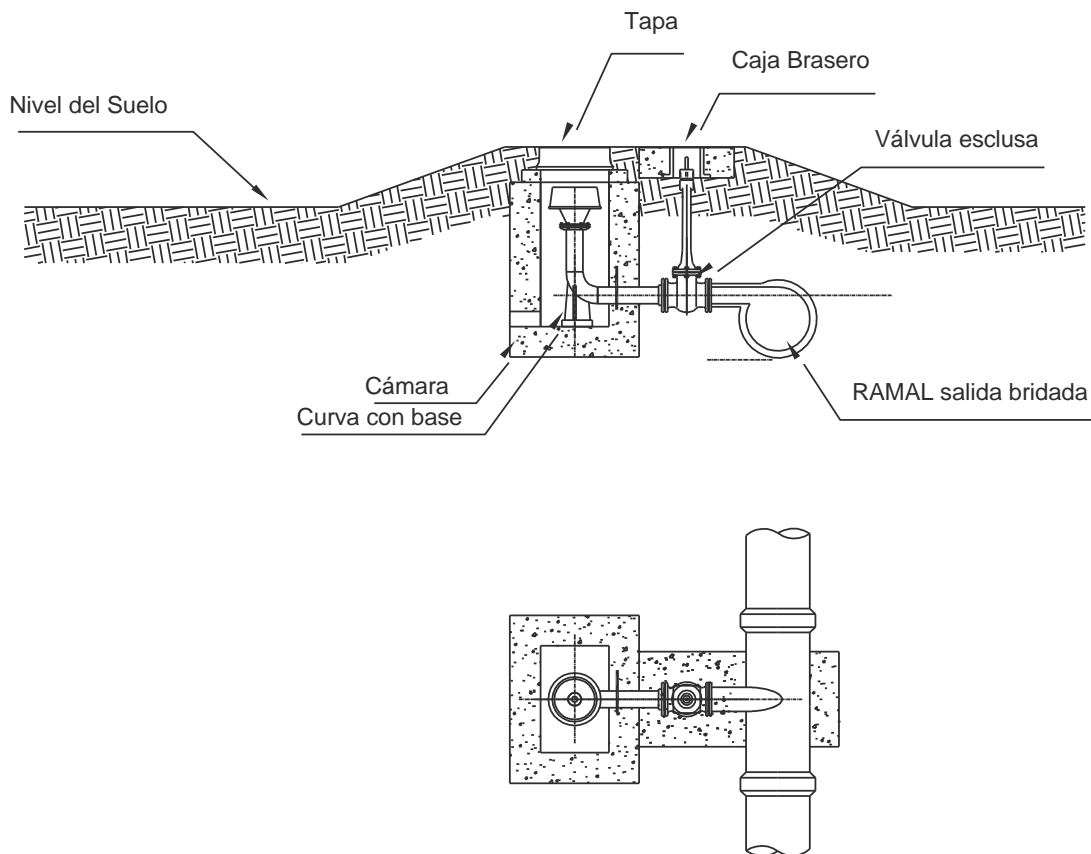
Plano de detalle tipo para una cámara válvula de aire
